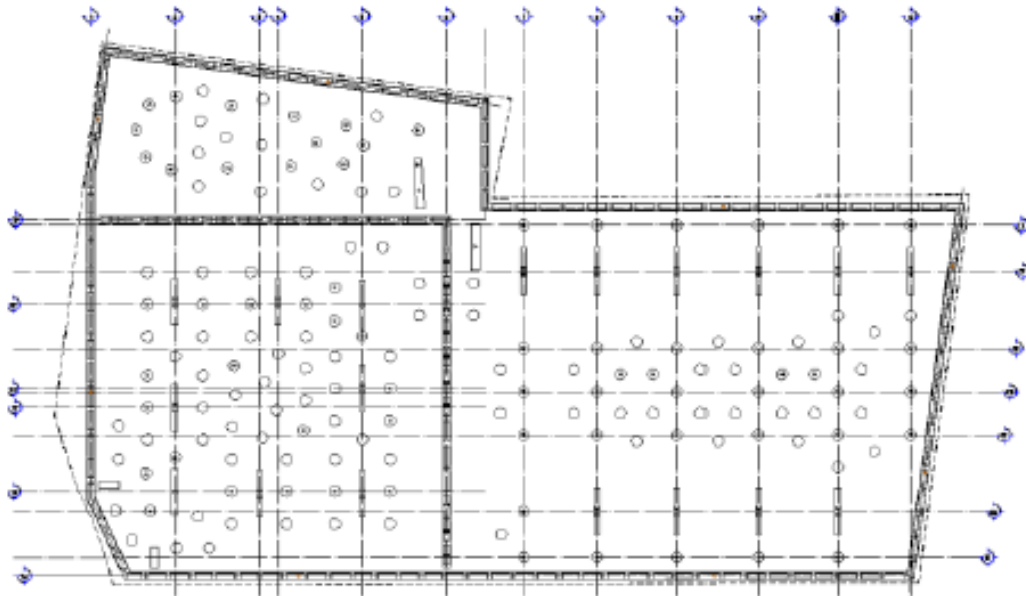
Ubicación en planta de Muro Milán y pilas.
